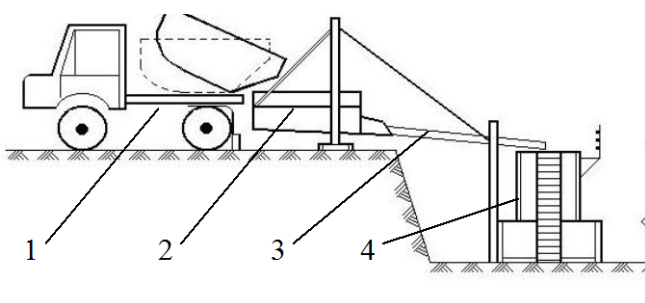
Бетонирование фундамента с разгрузкой бетонной смеси из транспортного средства непосредственно в опалубку:
